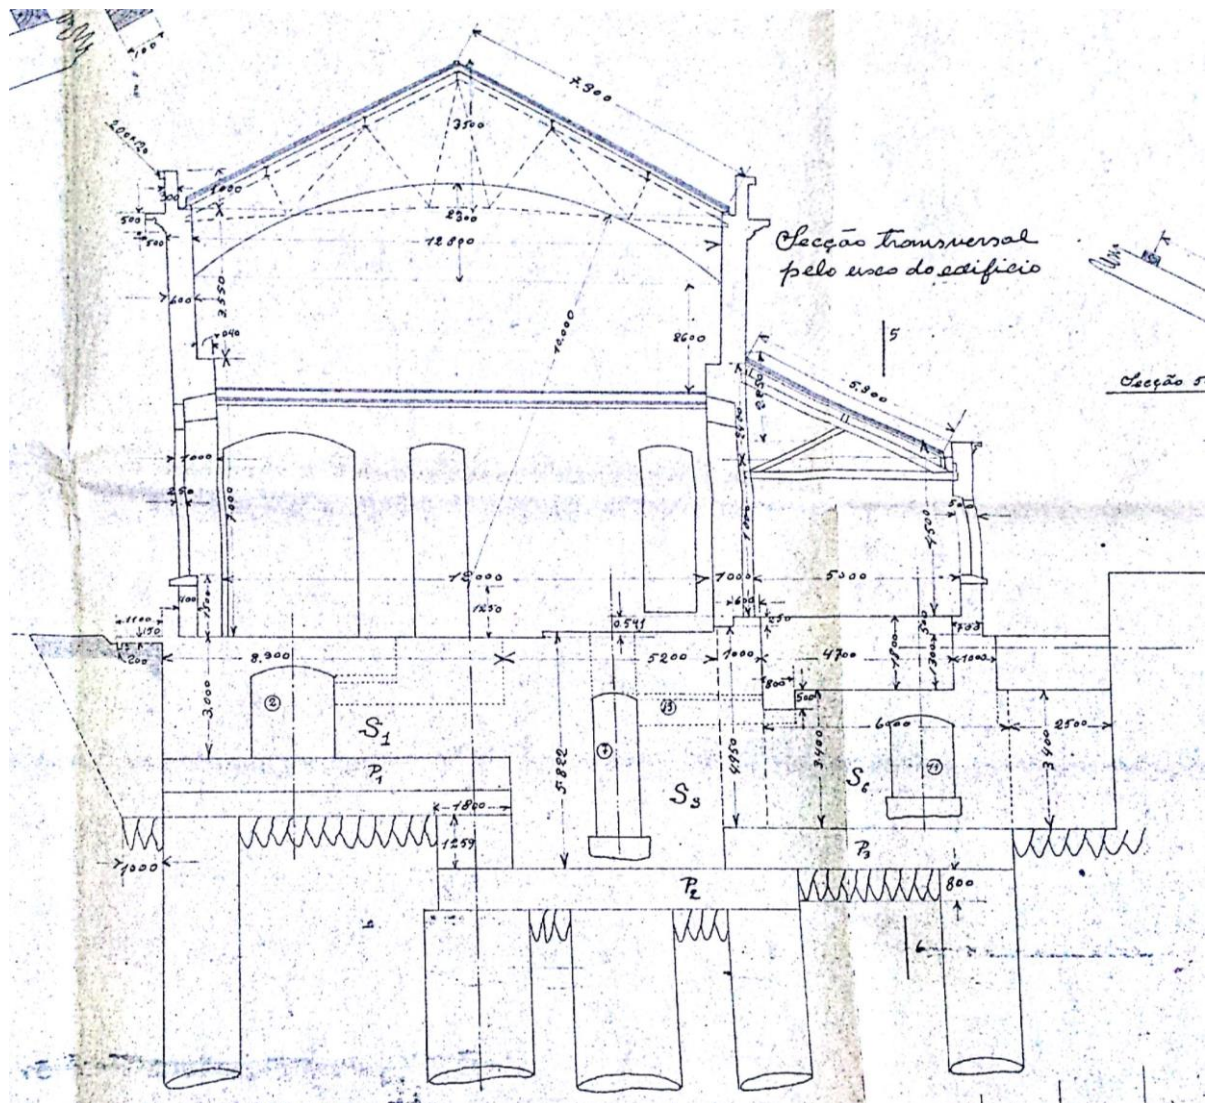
Secção transversal. Trecho da planta Casa da Força, CDS, 1912 (cópia).
